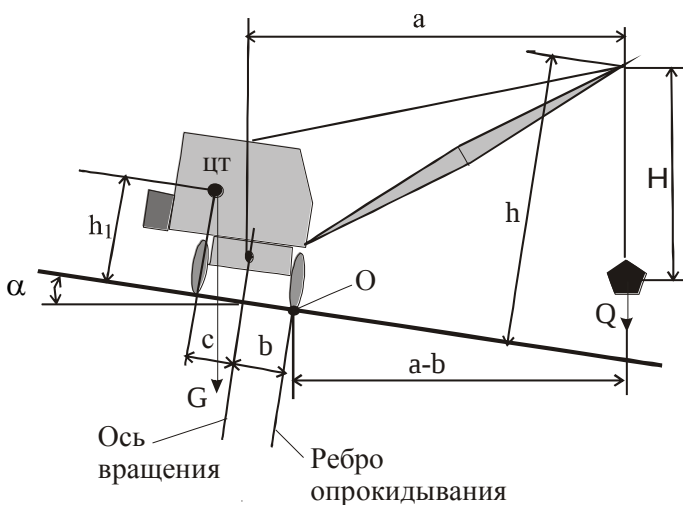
Расчетная схема грузовой устойчивости крана с грузом
